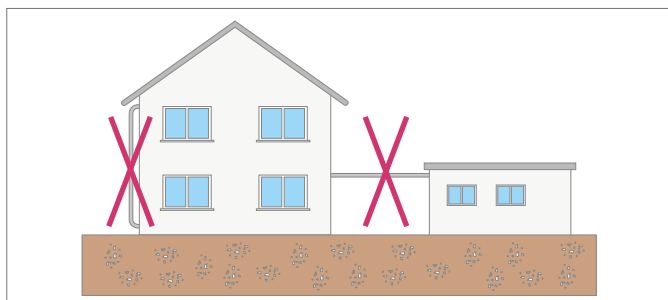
Укладка вне зданий труб для водопроводов возможна только с принятием соответствующих защитных мер
